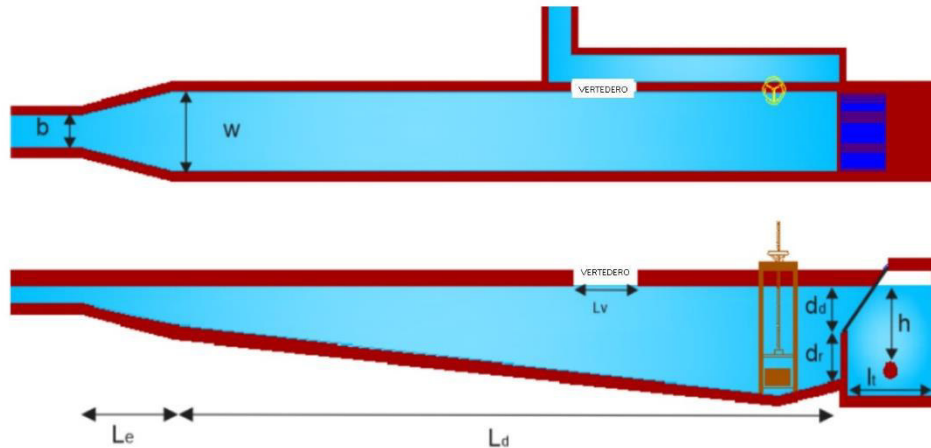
Detalle de la cámara de carga – desarenador
